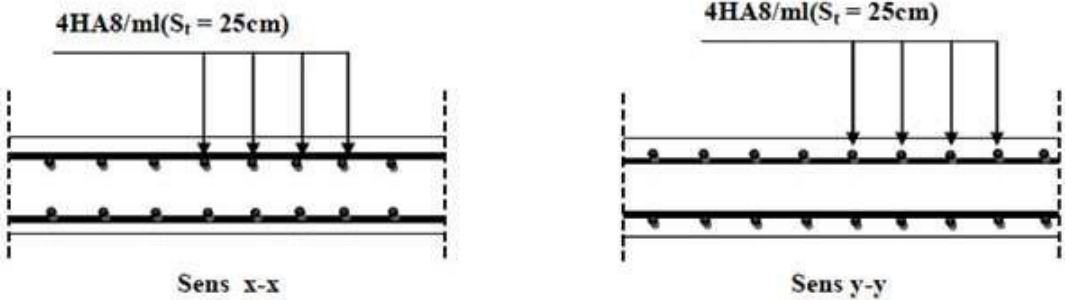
Ferrailage de la dalle pleine de la salle machine.
